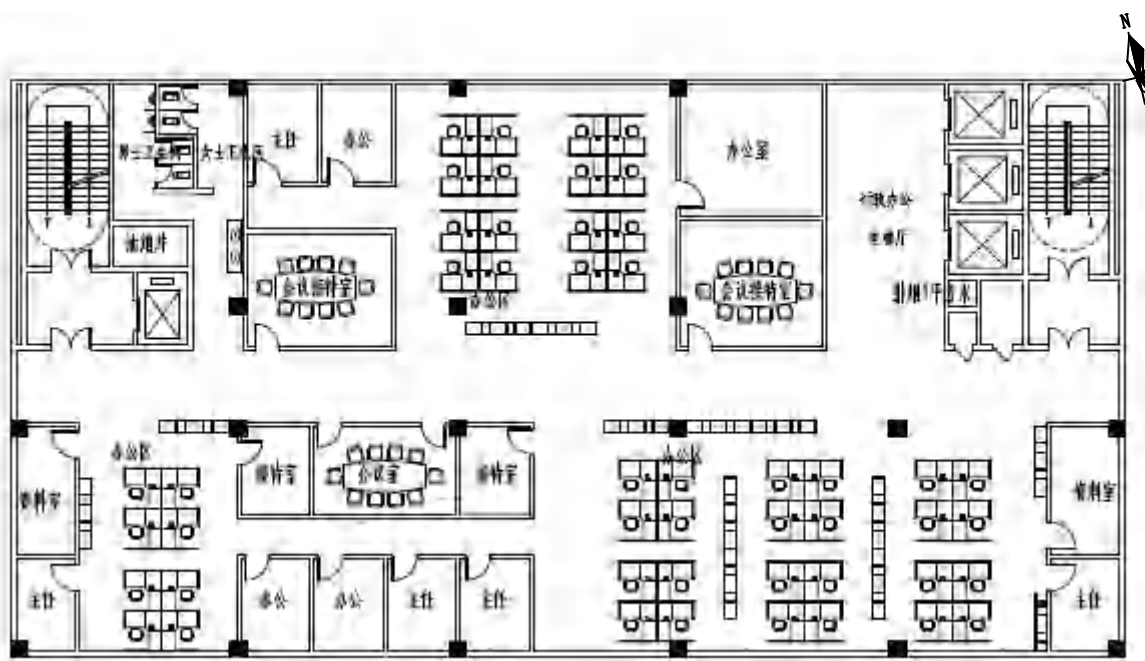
项目医疗综合楼裙楼—行政科研楼八层、十层平面布置图 (比例尺: 1:297)
